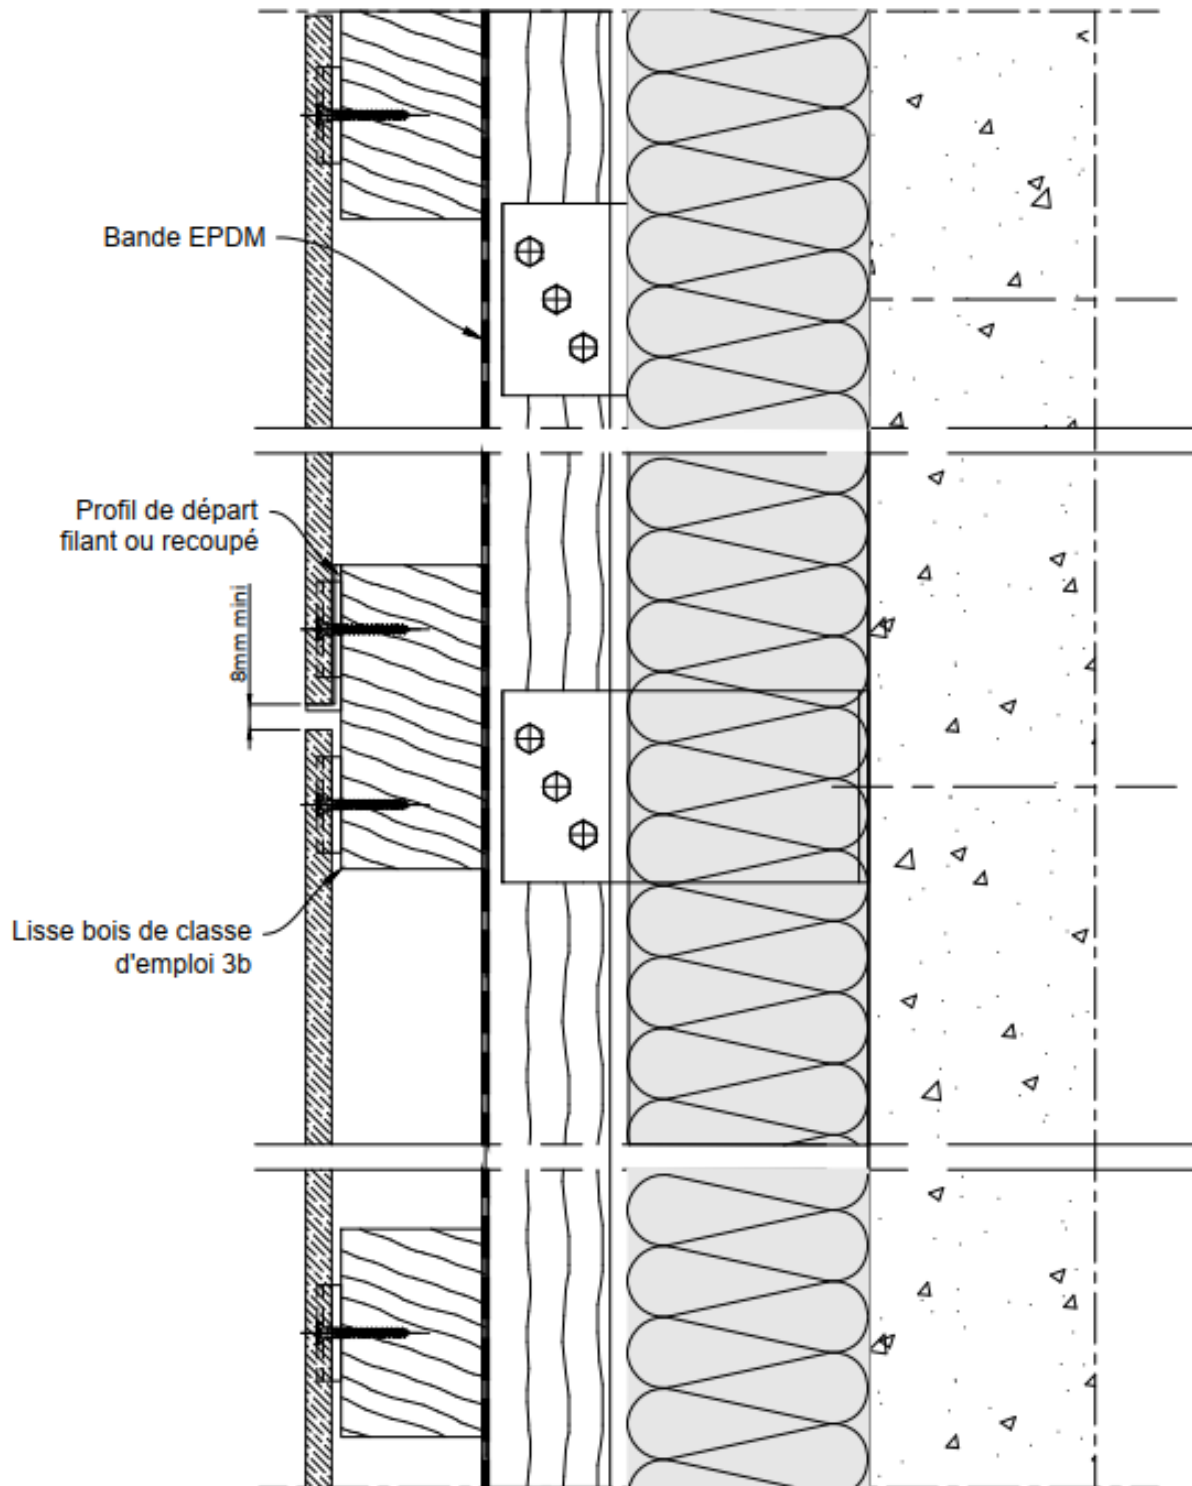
Pose verticale – joint horizontal (coupe verticale)
